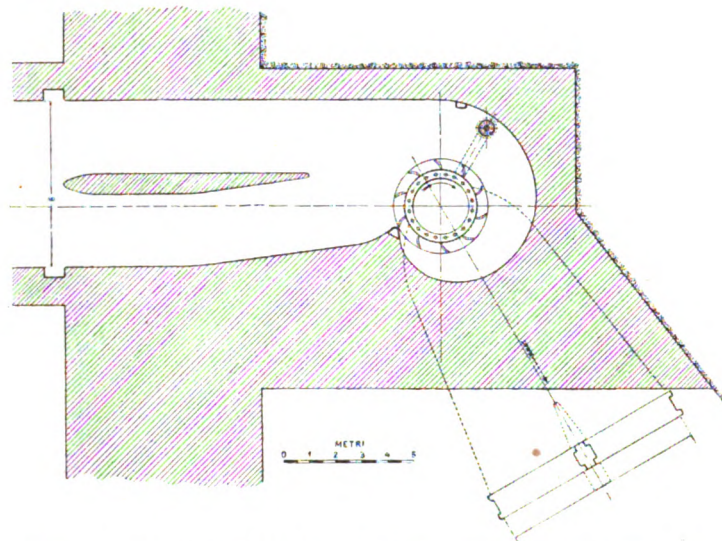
Pianta delle fondazioni con canali di presa e di scarico.
